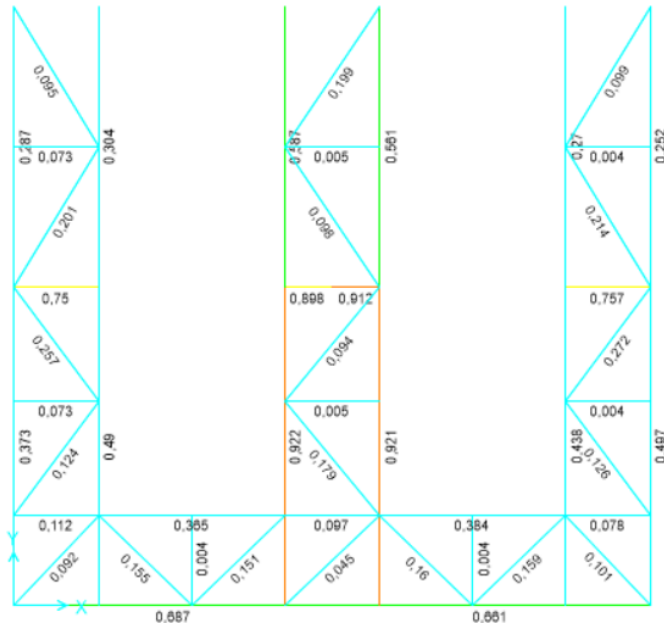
Factores de utilización vista en planta elevación 13 m.
